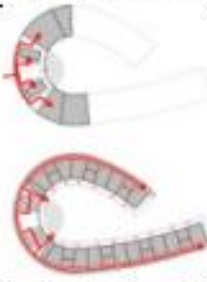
Exemple de toiture végétalisée et de mur masse, Oliver Kindergarten (source: archdaily.com)
